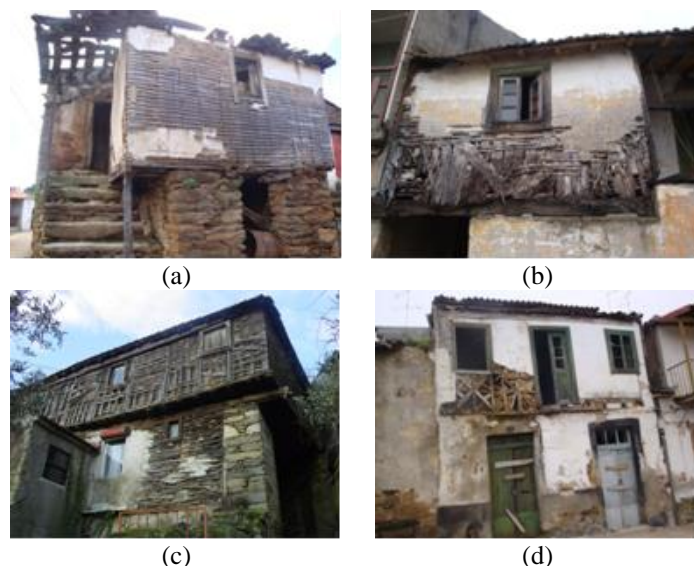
Soluções construtivas da estrutura de madeira de elementos de tabique; (a) tábuas verticais, Mirandela; (b) elementos diagonais, Mirandela; (c) estrutura modular dupla, Lamego; (d) em Cruz de Santo André, Vila Flor
